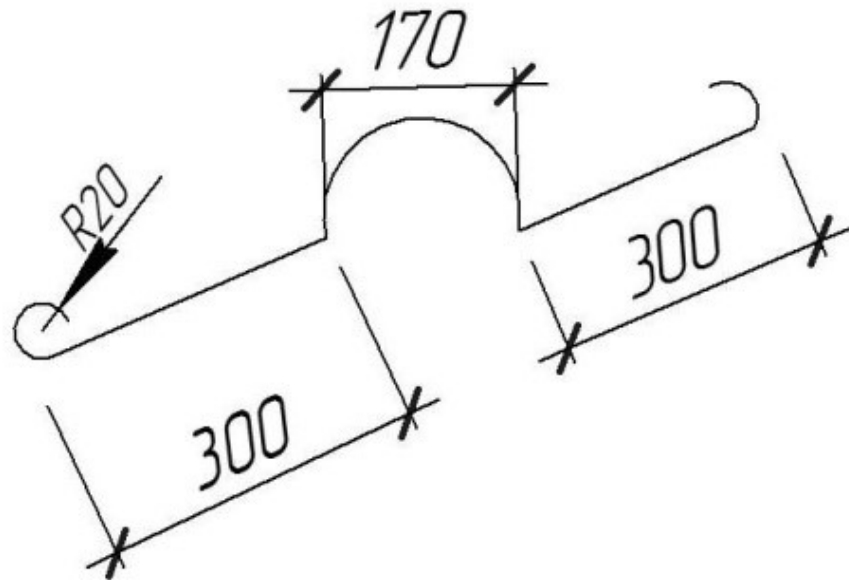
Конструювання кругло порожнистої плити перекриття
